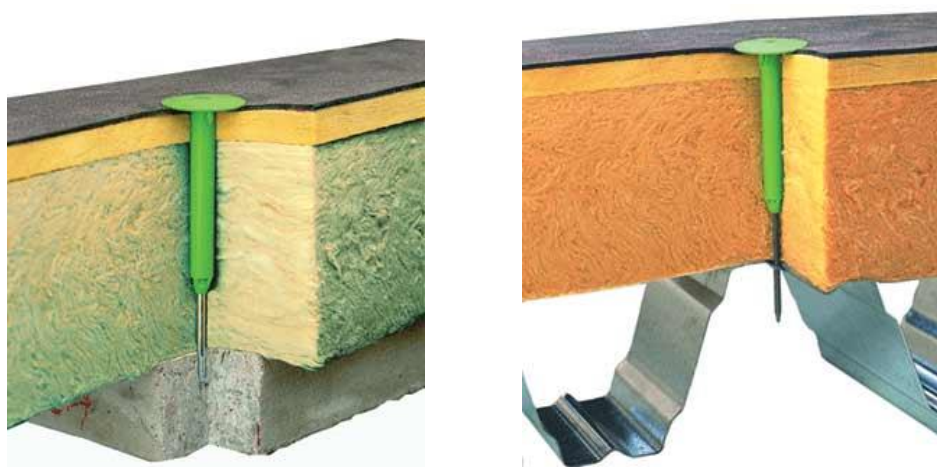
Крепление нижнего слоя кровельного ковра к основанию
